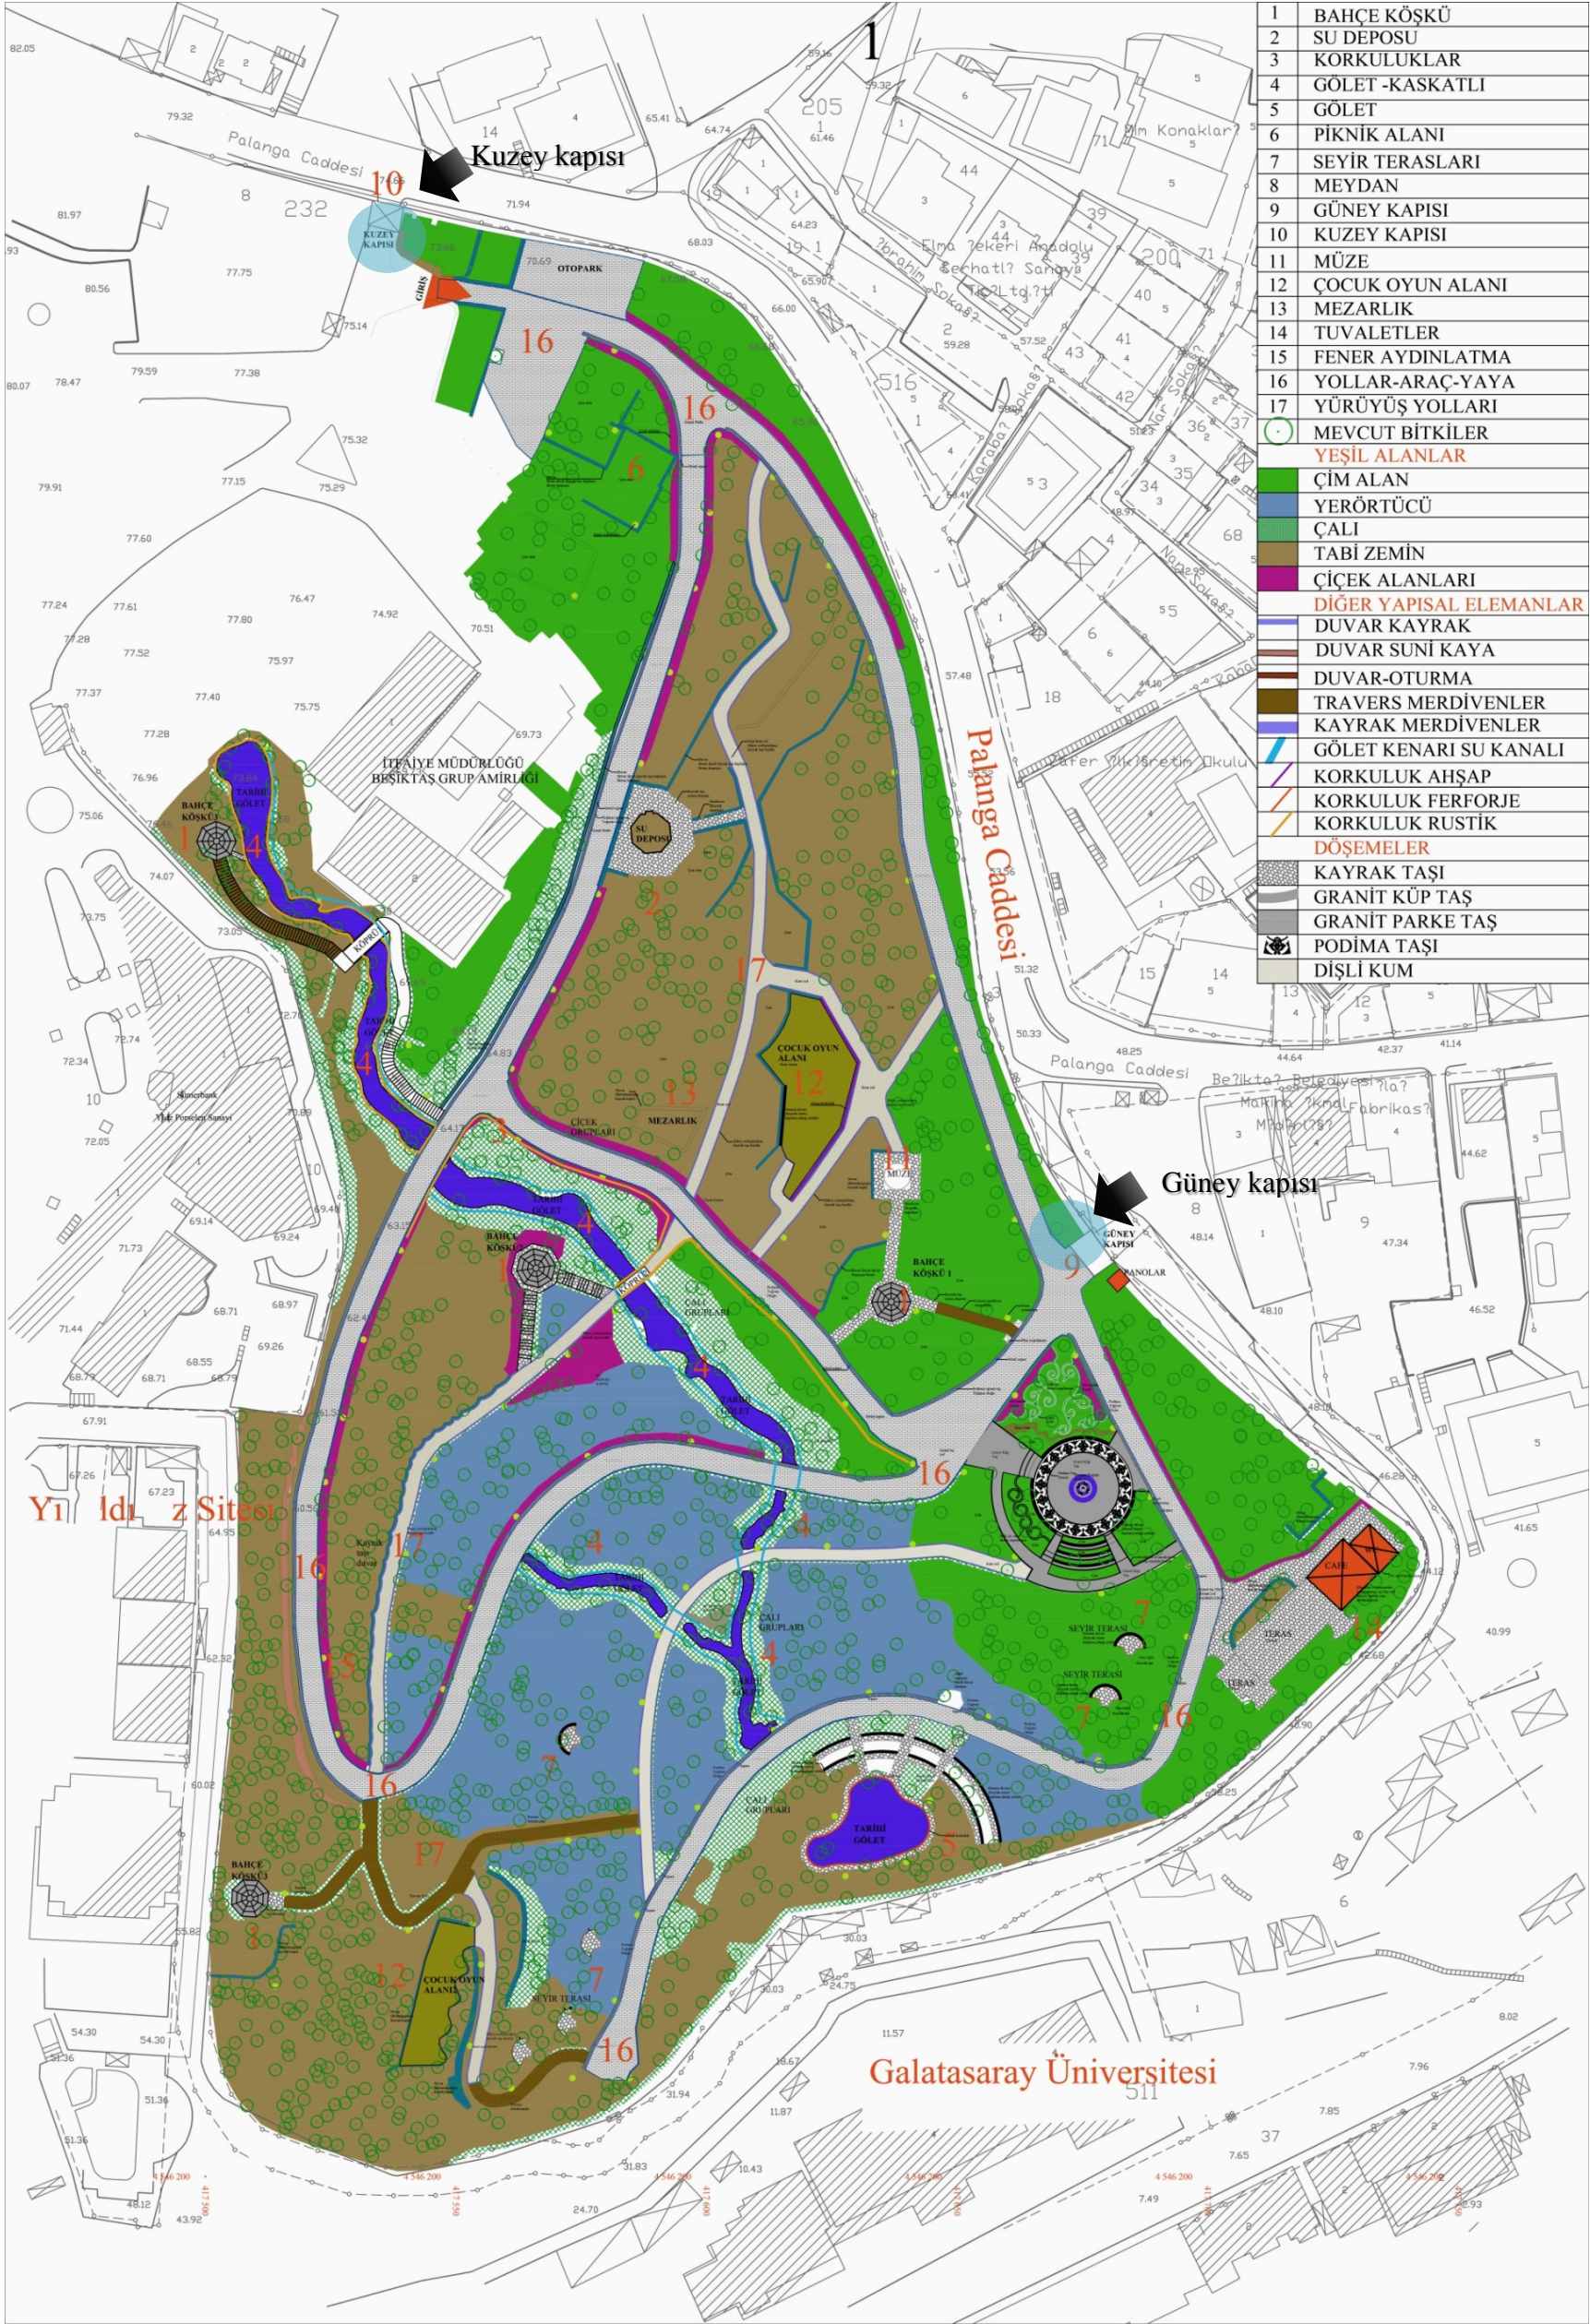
Has Ağillar Kısımı'nı gösterir plan.
